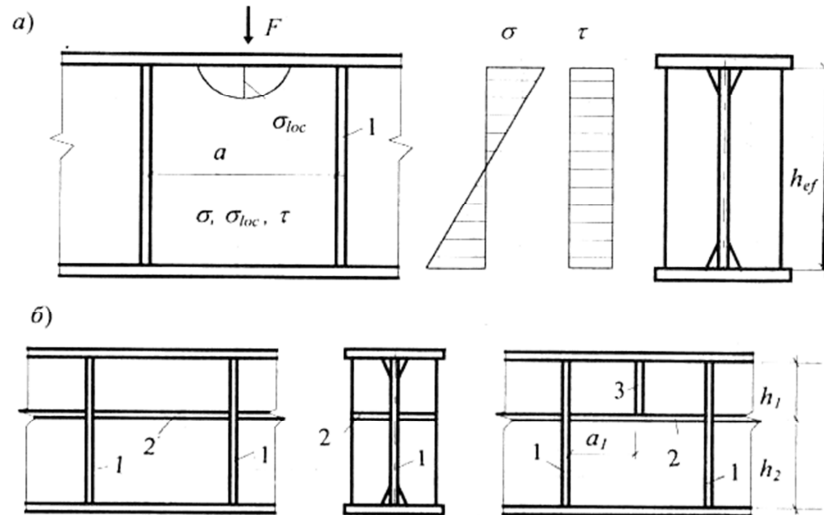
Схема балки, укрепленной поперечными и продольными ребрами жесткости: 1 – поперечное ребро, 2 – продольное ребро, 3 – дополнительное поперечное ребро
